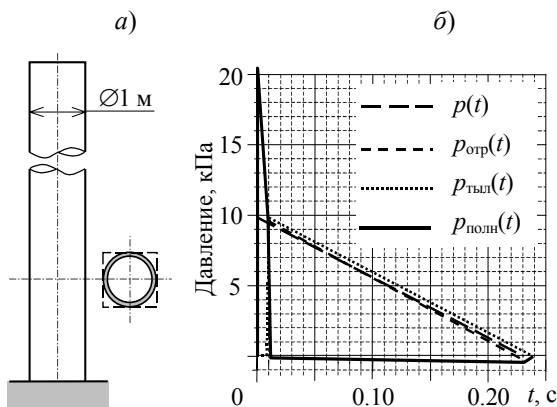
Нагрузки при взрыве на вентиляционную трубу:
